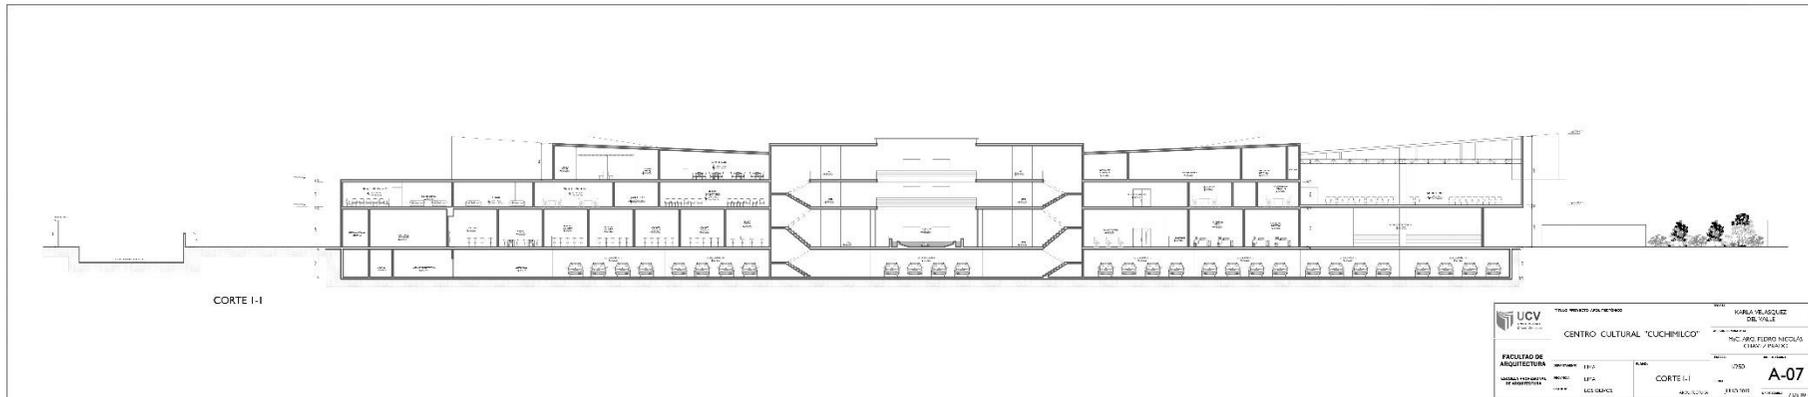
Plano de Arquitectura Corte 1-1. Elaboración propia
